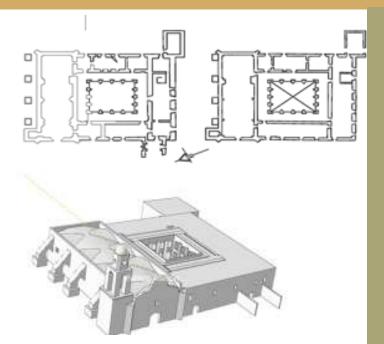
Planta y Edificio en 3d de la Iglesia y exconvento de Tetela del volcán
